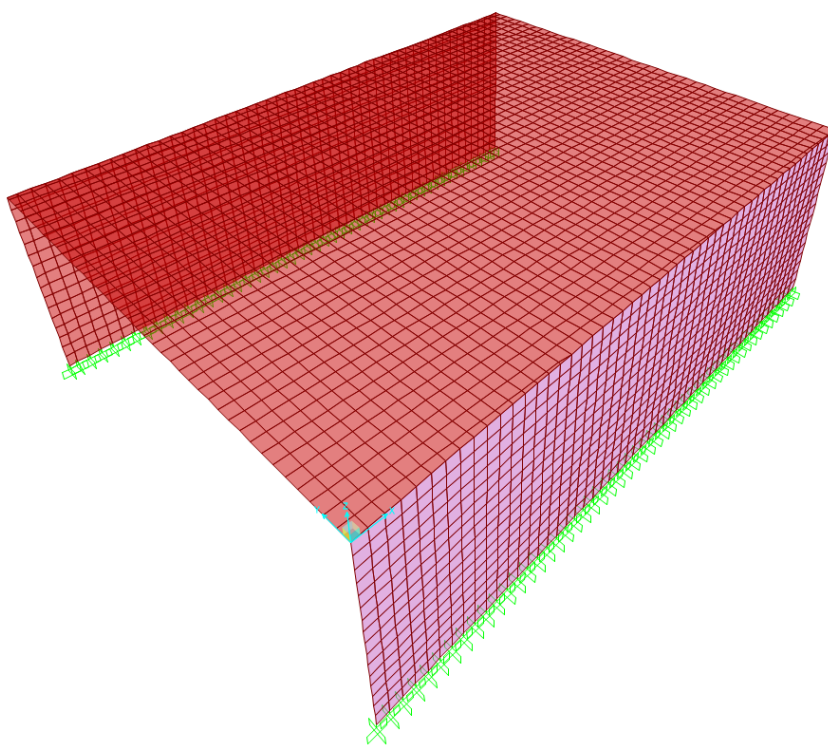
Vista 3D del modelo de cálculo de las estructuras E3 y E4
